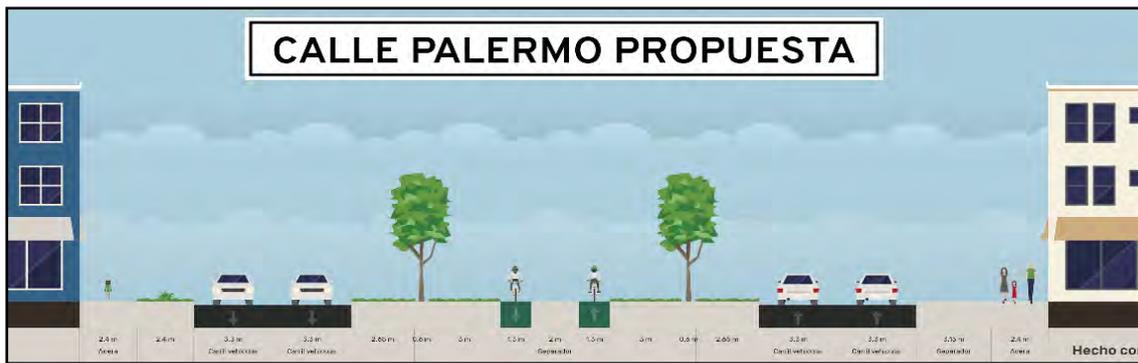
Situación propuesta de la sección típica de la Calle Palermo.
